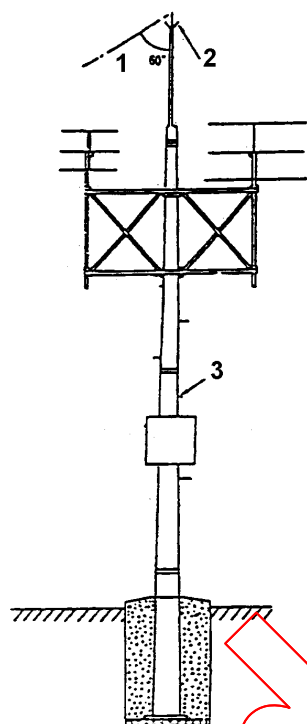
Exemple d'installation d'un dispositif de sécurité au Japon
